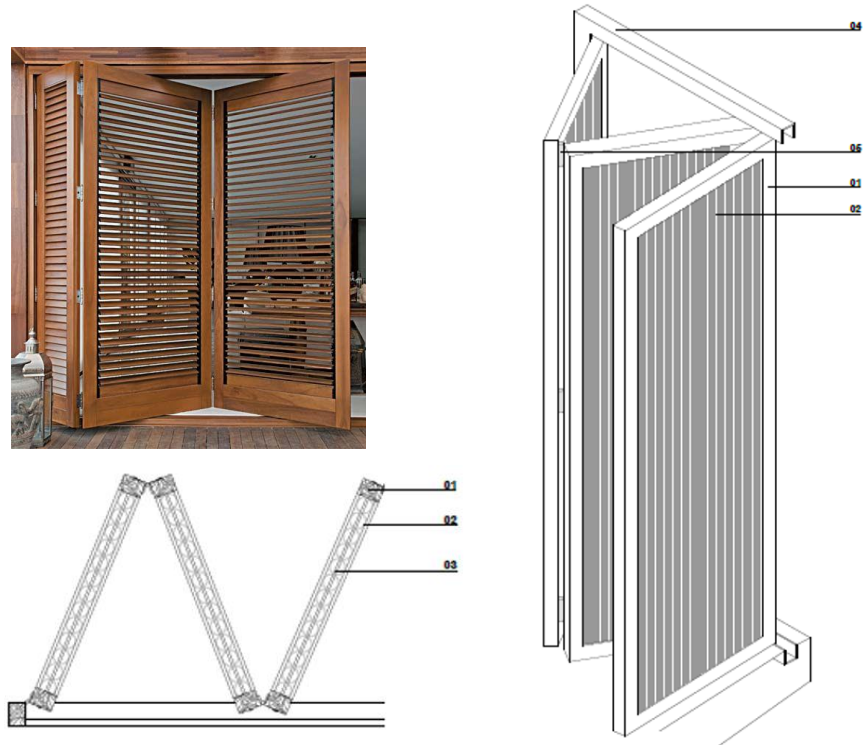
Puerta plegable de madera. Fuente: Elaboración propia
